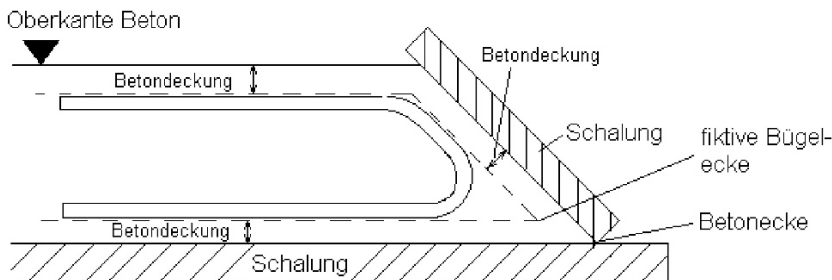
Der in einer spitzen Schalung DIN-gerecht eingebaute Betonstahlbügel.
